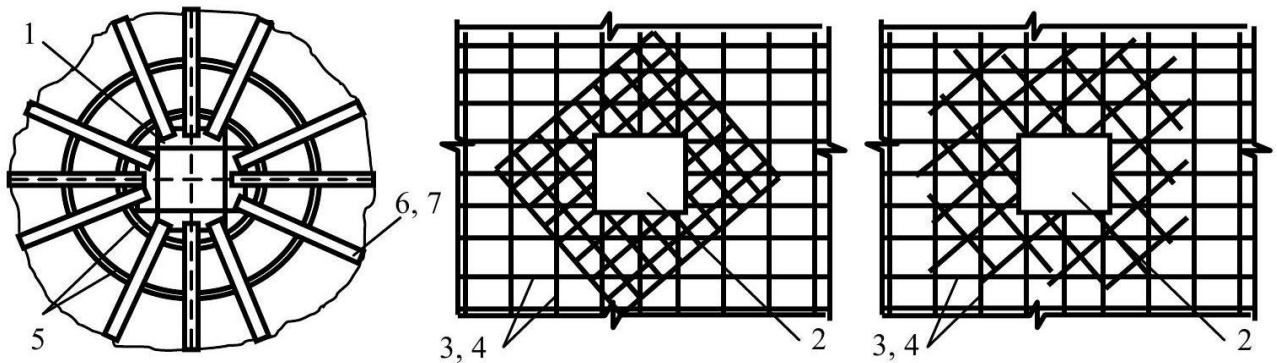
Схема армування плити перекриття збірного безригельного каркаса будівлі:
